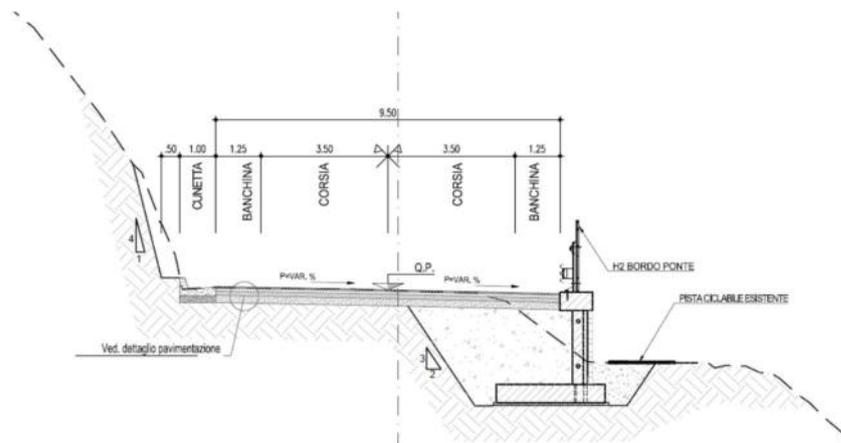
Sezione tipo con muro in progetto e pista ciclabile esistente (lato valle)
